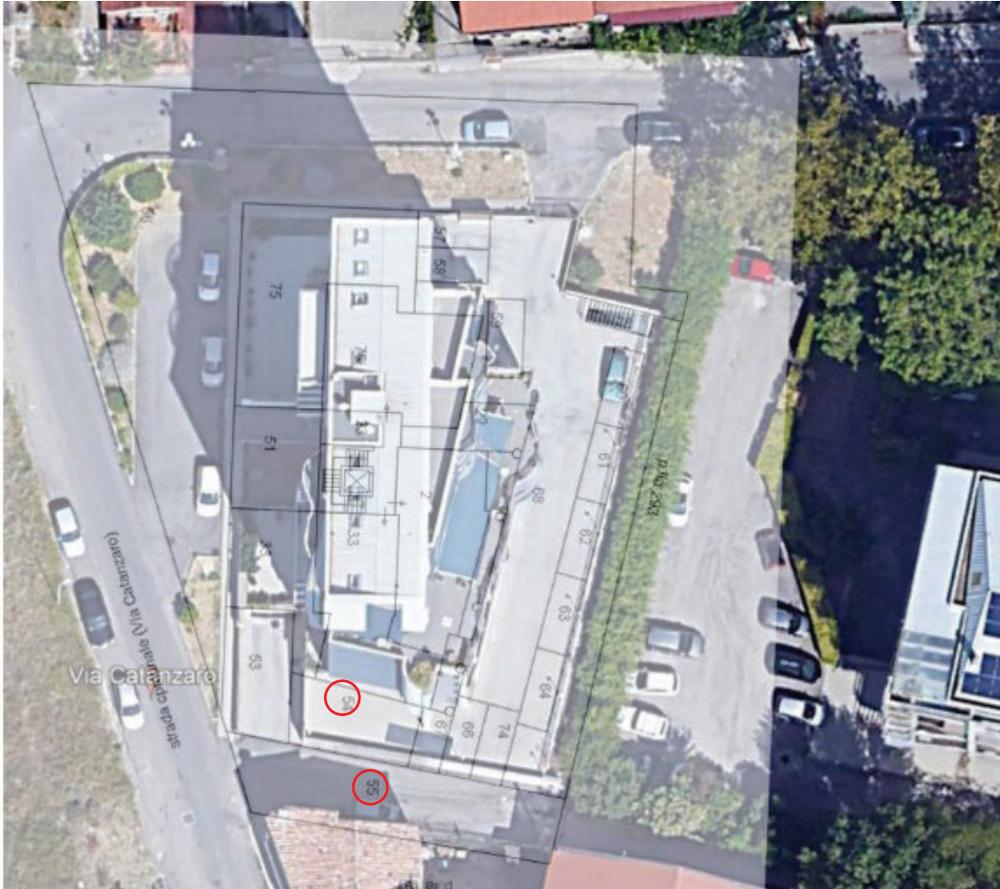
sovrapposizione foto aerea - elaborato planimetrico.
